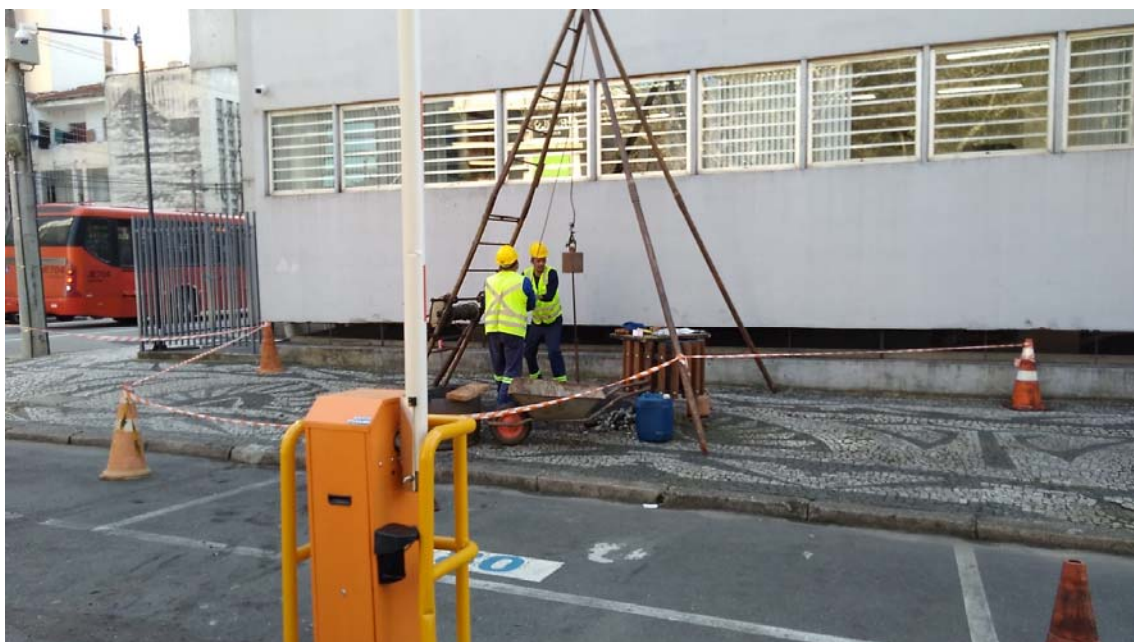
Outra imagem da perfuração do furo SP-07. Foto do autor.
